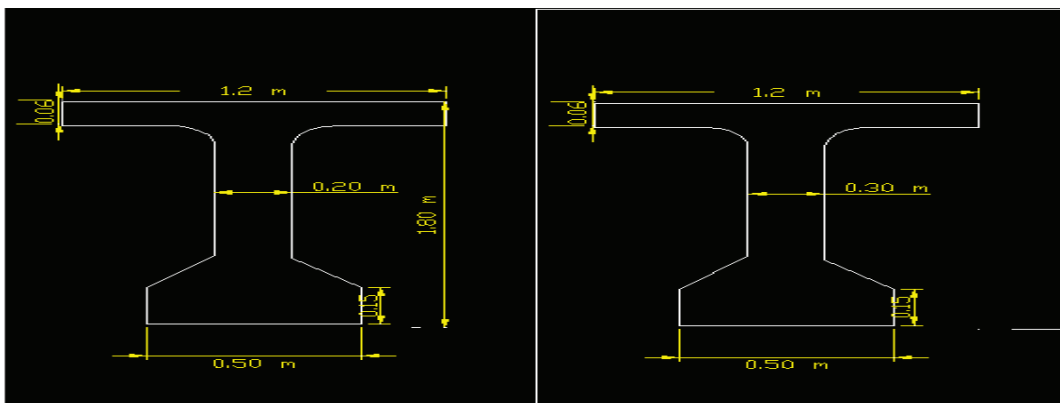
coupe transversale de la poutre en travée - à l'appui
